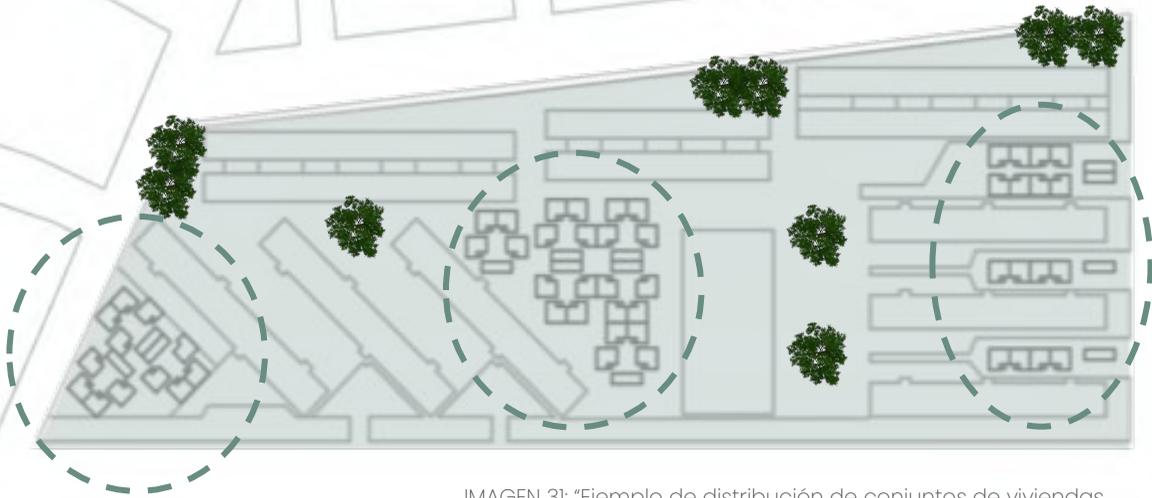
"Ejemplo de distribución de conjuntos de viviendas dentro del Multifamiliar Tlalpan". (2018). Elaboración en equipo.
